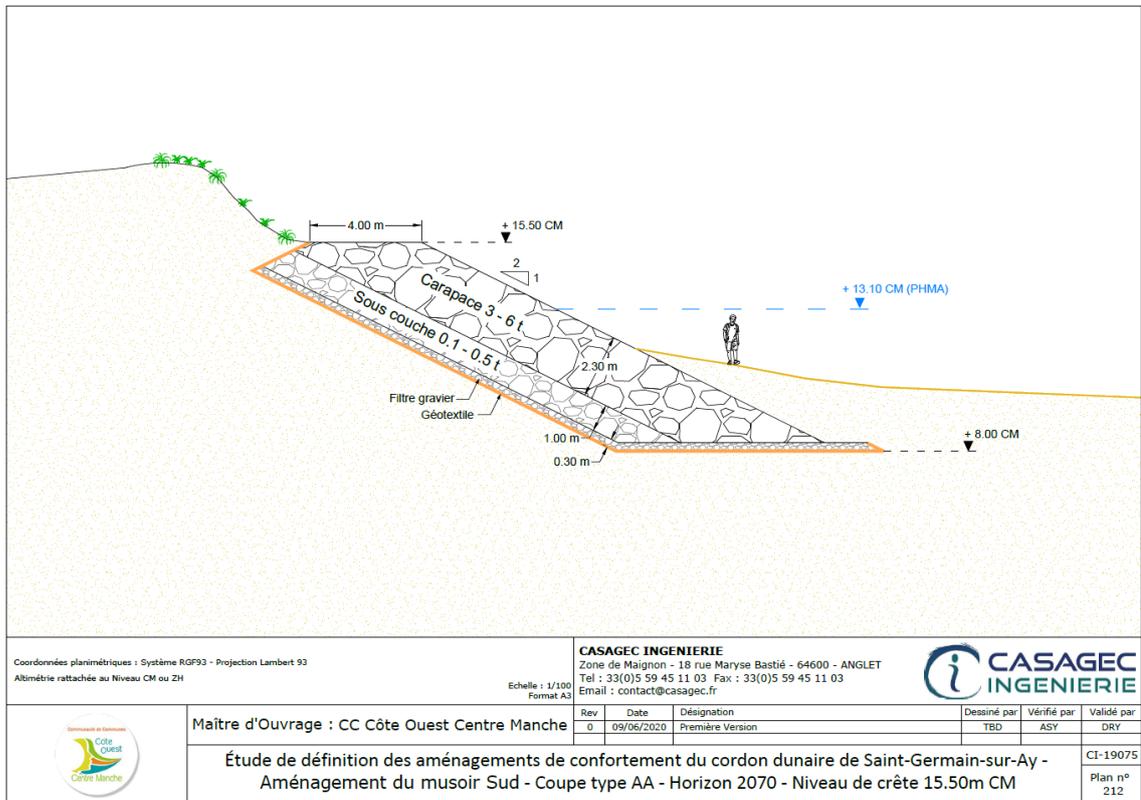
Section-type 3 de l'ouvrage présentant une cote de crête à 15,5 m CM et une carapace constituée de blocs 3-6t (horizon 2070)
